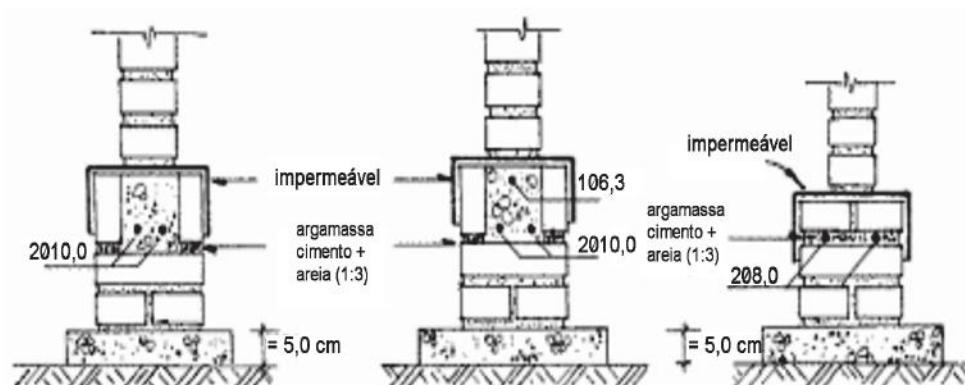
sapatas de alvenaria com com cinta de amarração e impermeabilização.
